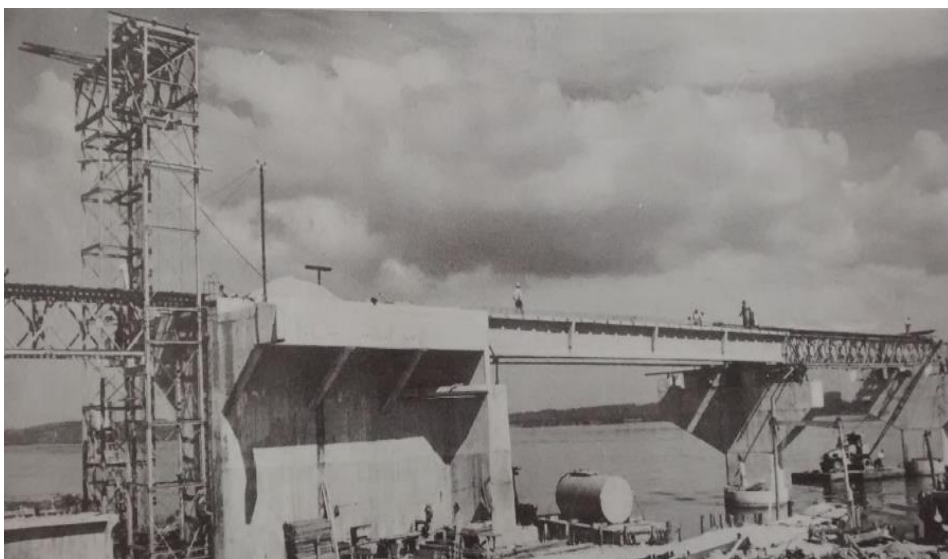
Colocación de las vigas prefabricadas con ayuda de la grúa deslizante [1.2].
